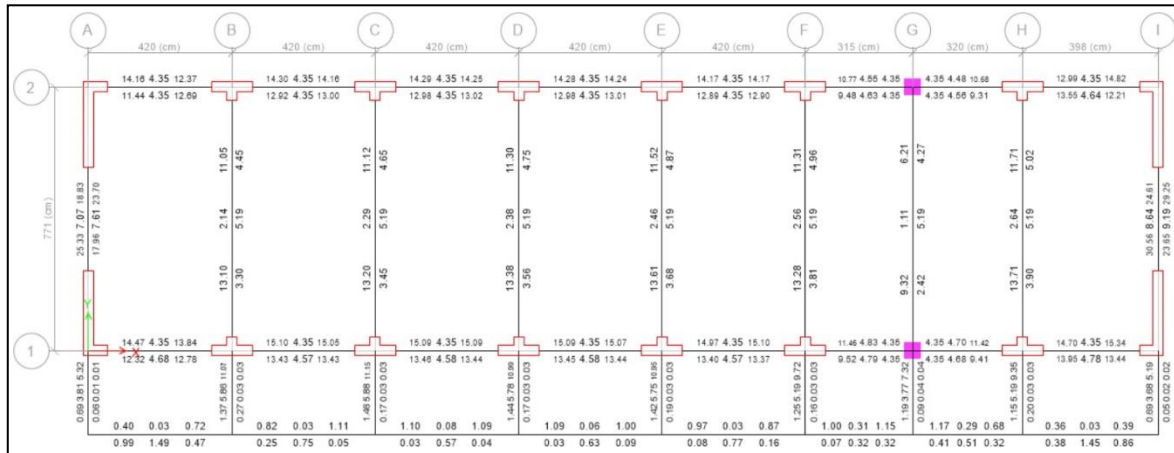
Cuantías calculadas en vigas del segundo techo (crítico, cm²)
